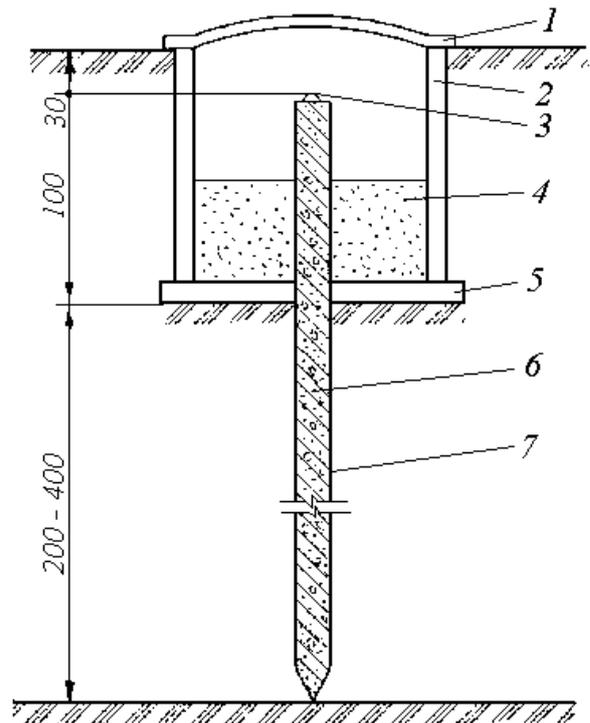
Грунтовой свайный репер, устанавливаемый забивкой или в котловане ниже глубины промерзания на 1–2 м:
